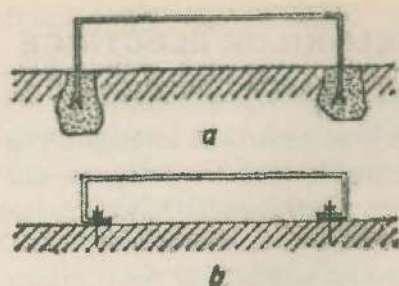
Consolă pentru montarea aparentă a tuburilor :
